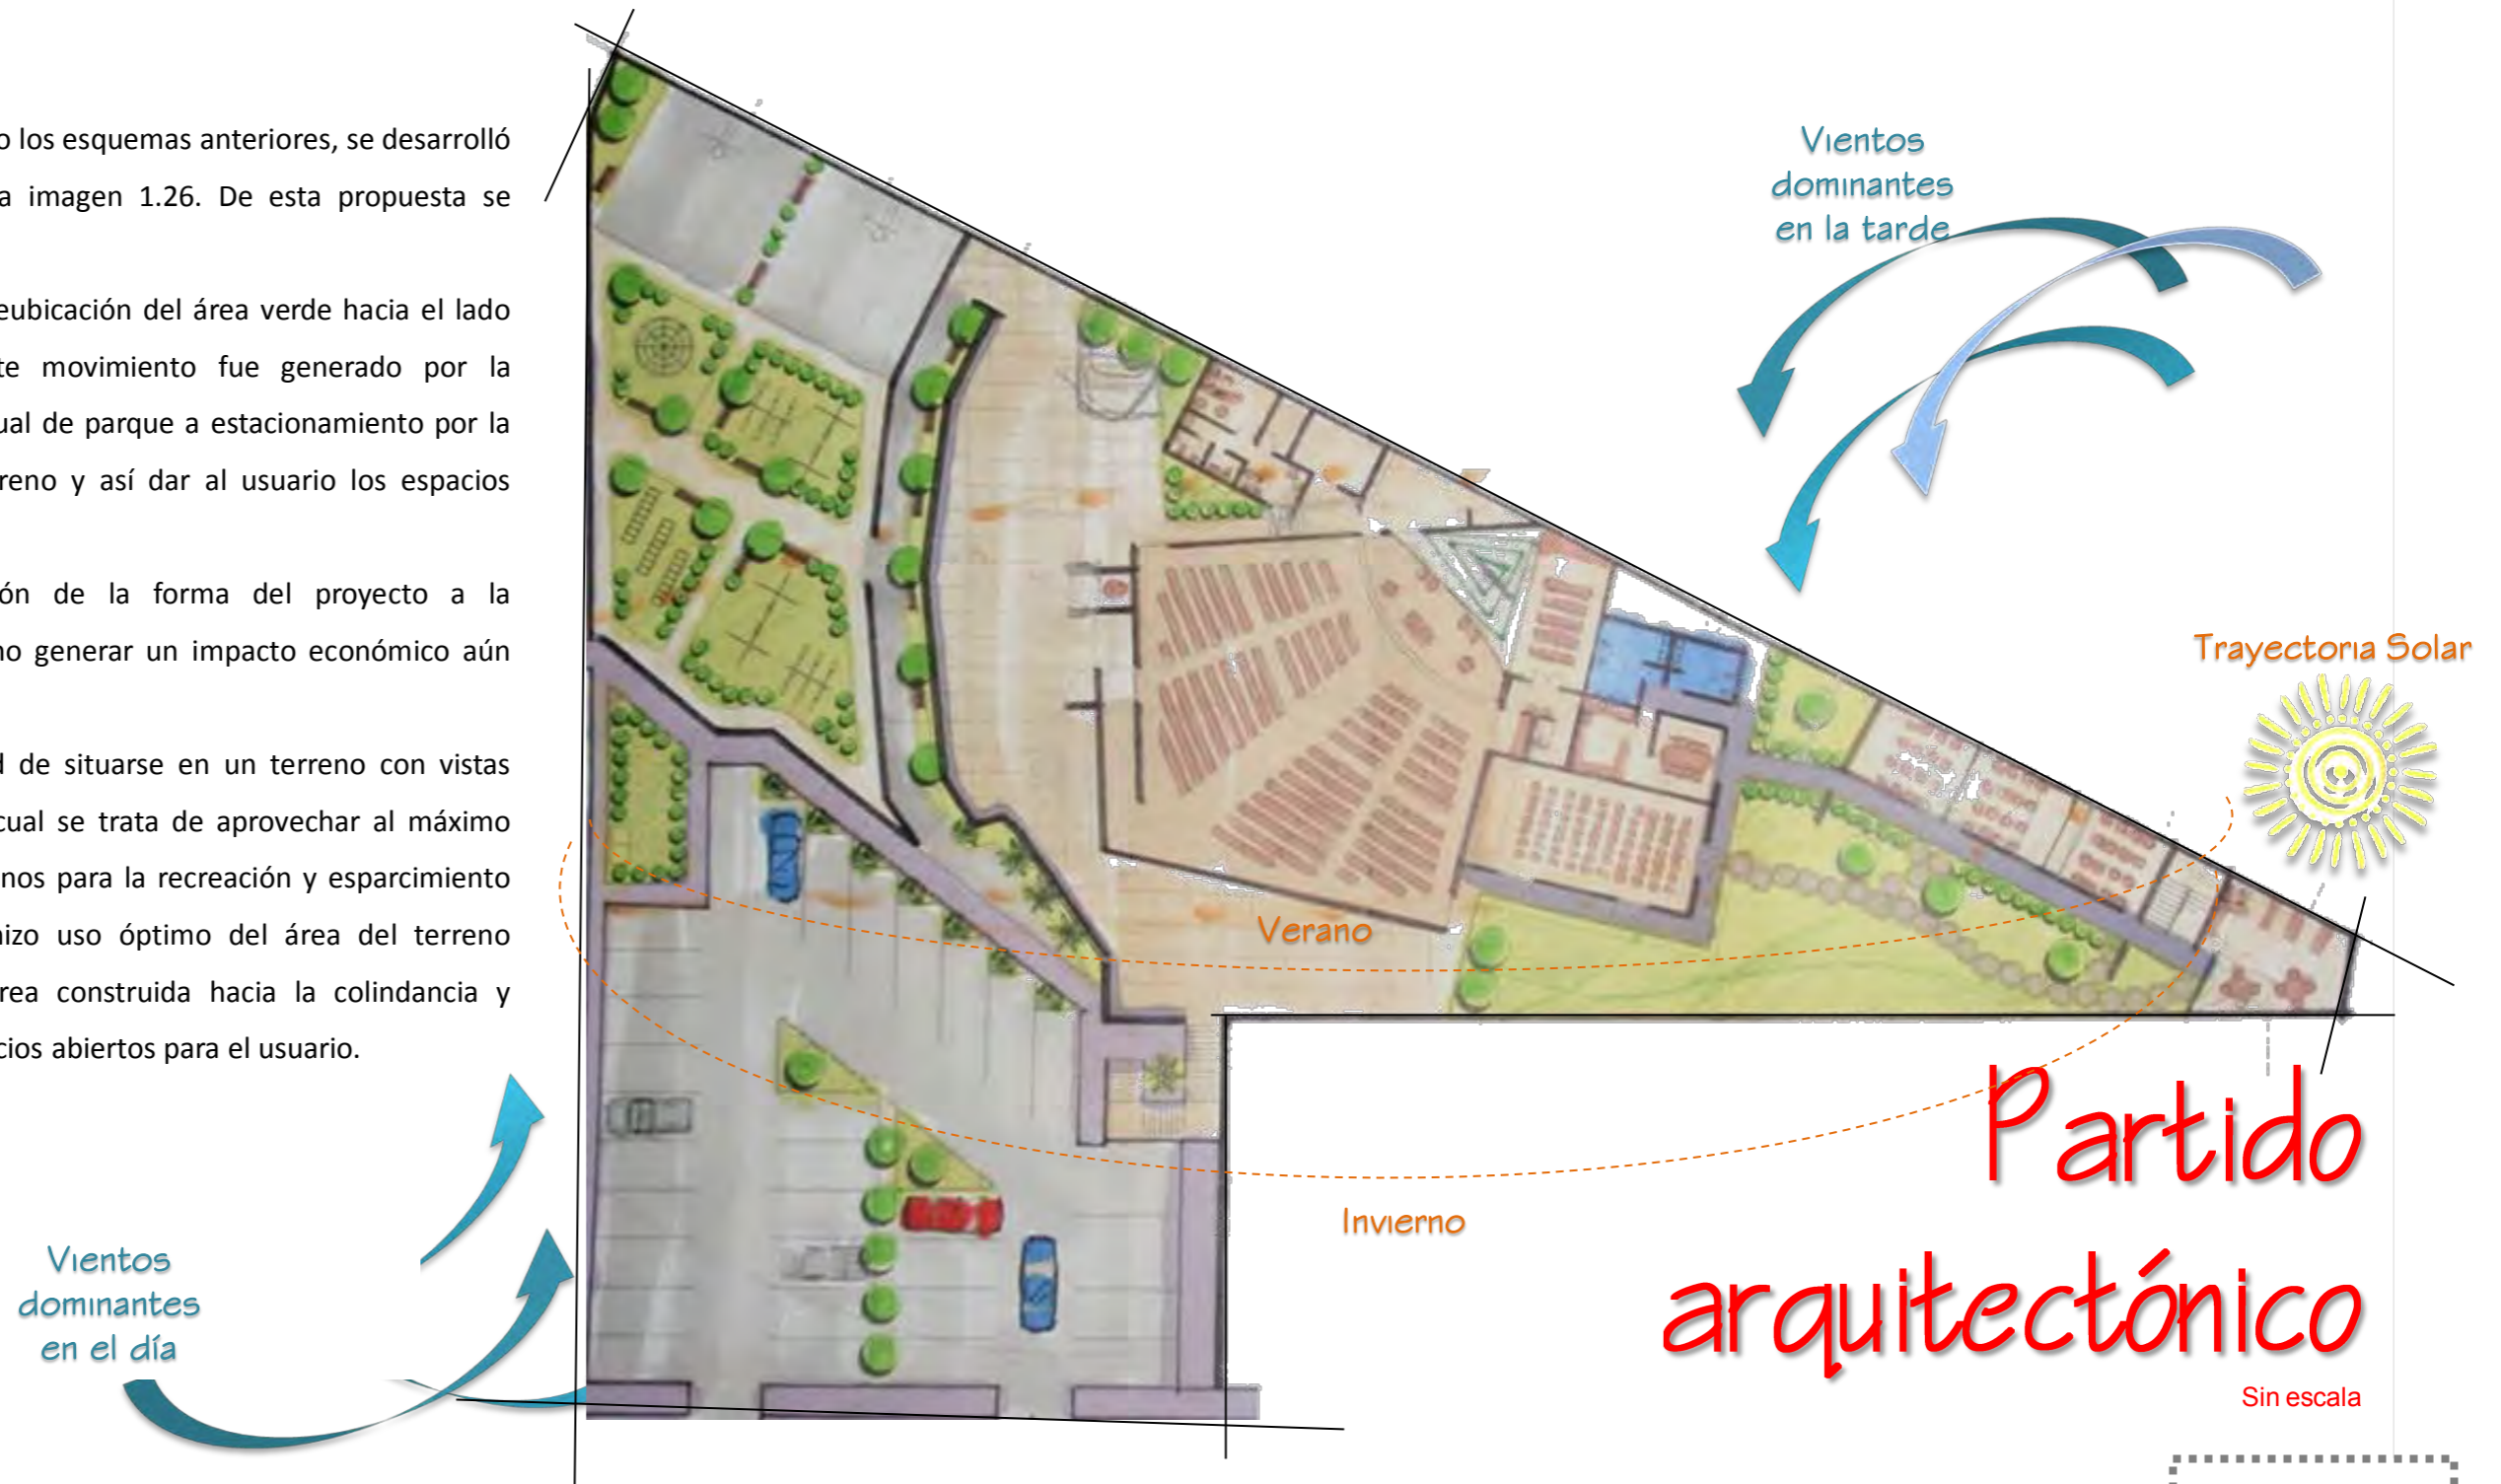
Vista en planta del partido arquitectónico del proyecto. Fuente propia.
